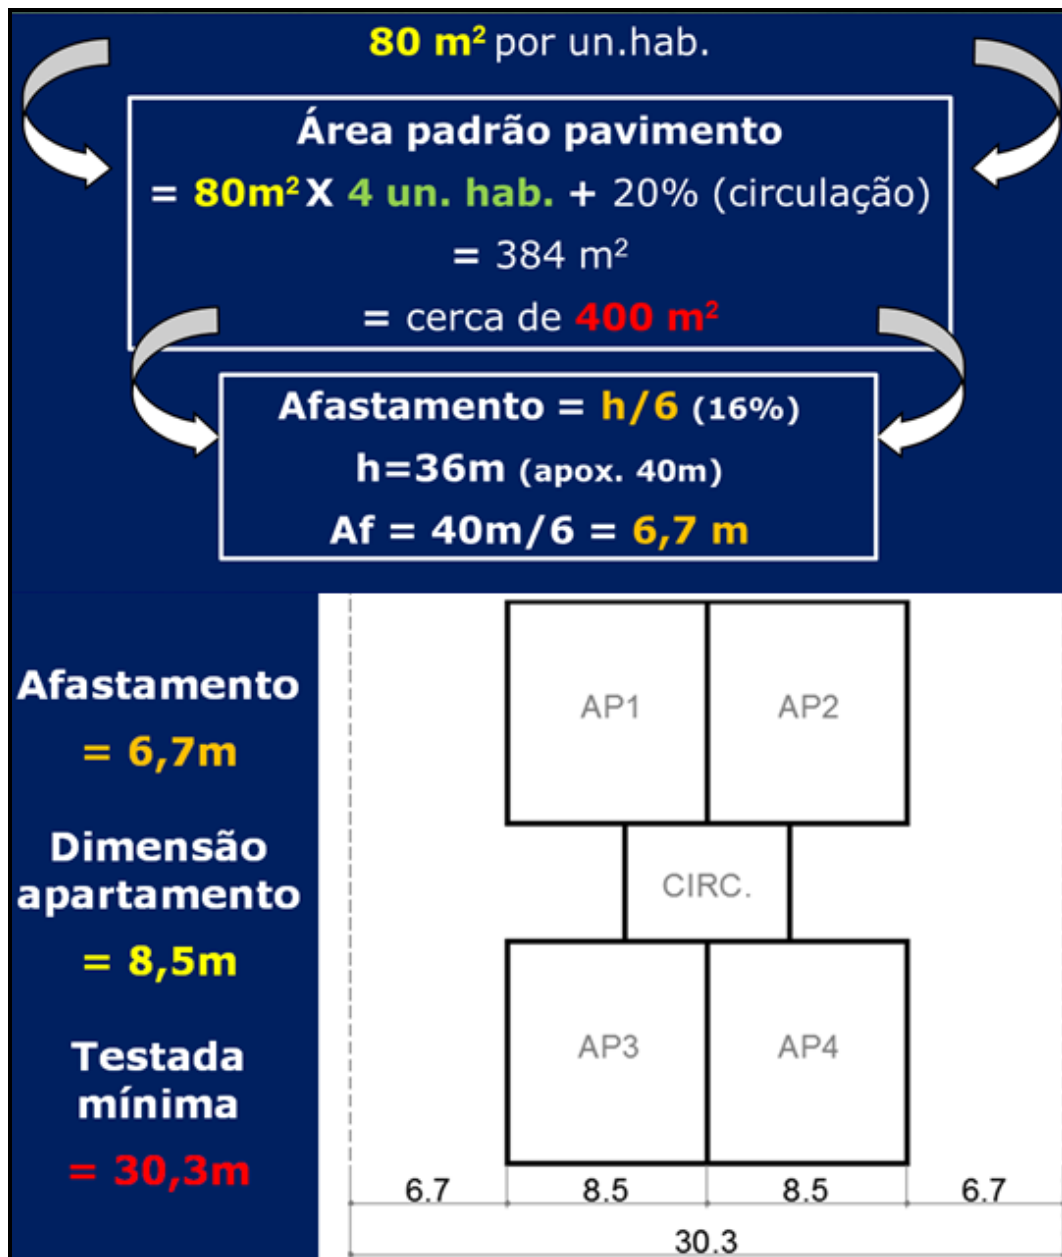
Cálculo do lote padrão para edifício de 12 pavimentos.
